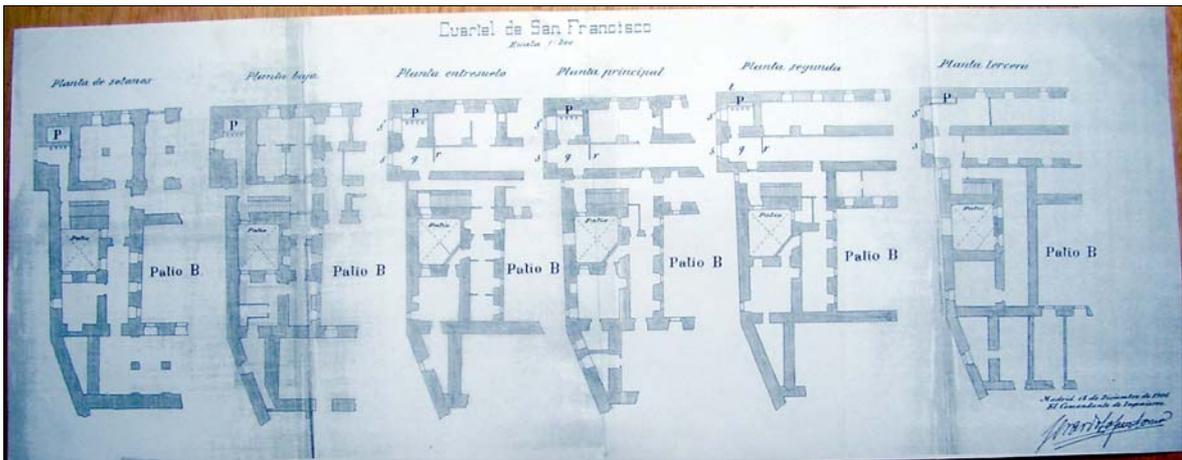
Cuartel de San Francisco. Levantamiento planimétrico de los distintos niveles que componen el ángulo nororiental del cuartel: sótanos y plantas baja, entresuelo, principal, segunda y tercera. Escala original, 1:200. Archivo General Militar, Sección 3ª., división 3ª., leg. 580.
